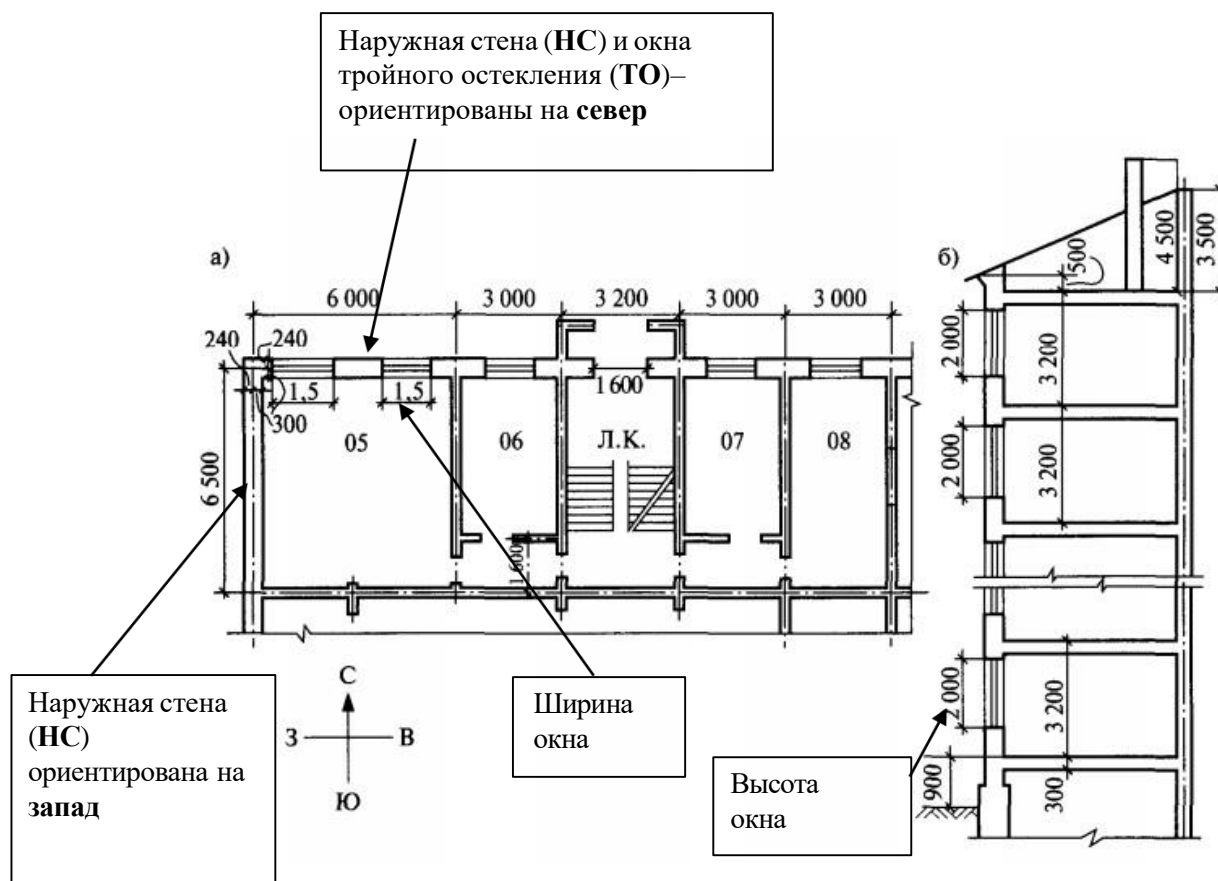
План и разрез здания: а – фрагмент плана этажа; б – разрез 1-1.
